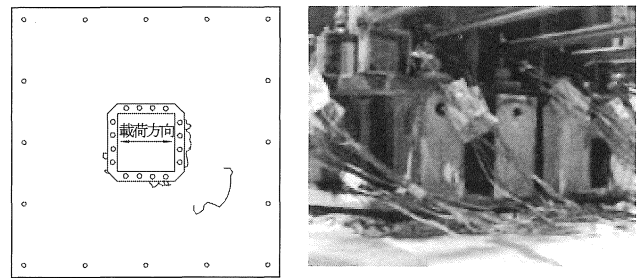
フーチングひび割れ状況 写真1 ベースプレートの浮き上がり
